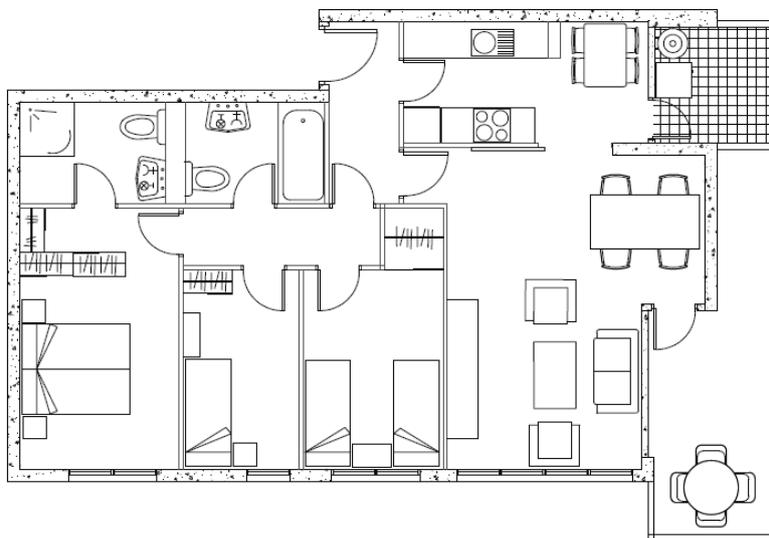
Plano de planta de la vivienda tipo considerada y su contenido.
